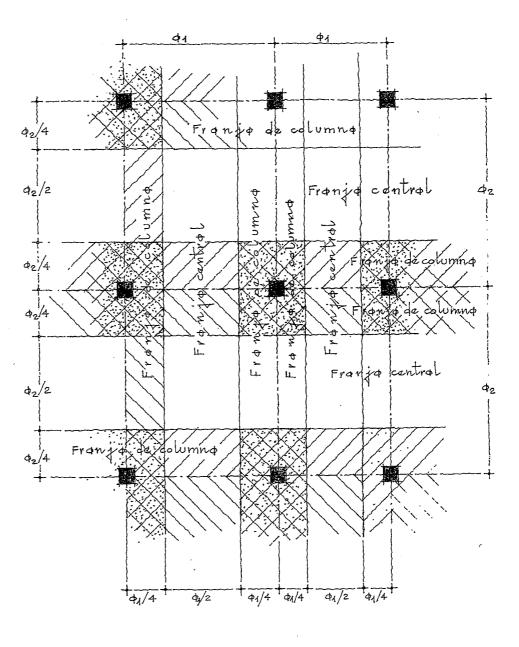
Franjas utilizadas en el diseño de una losa plana.
